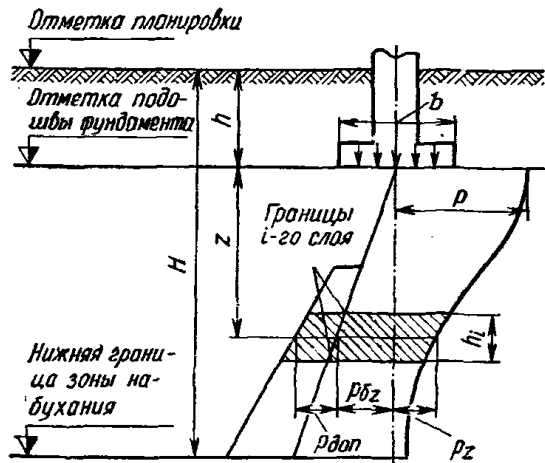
Схема для расчета подъема оснований при набухании грунта
